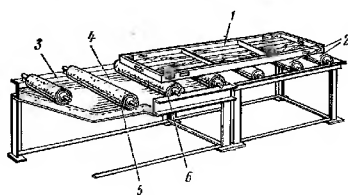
Устройство для смазки опалубочных щитов: 1 — щит; 2 — ролик; 3 — валик; 4 — смазка; 5 — смазывающие валики; 6 — войлок
